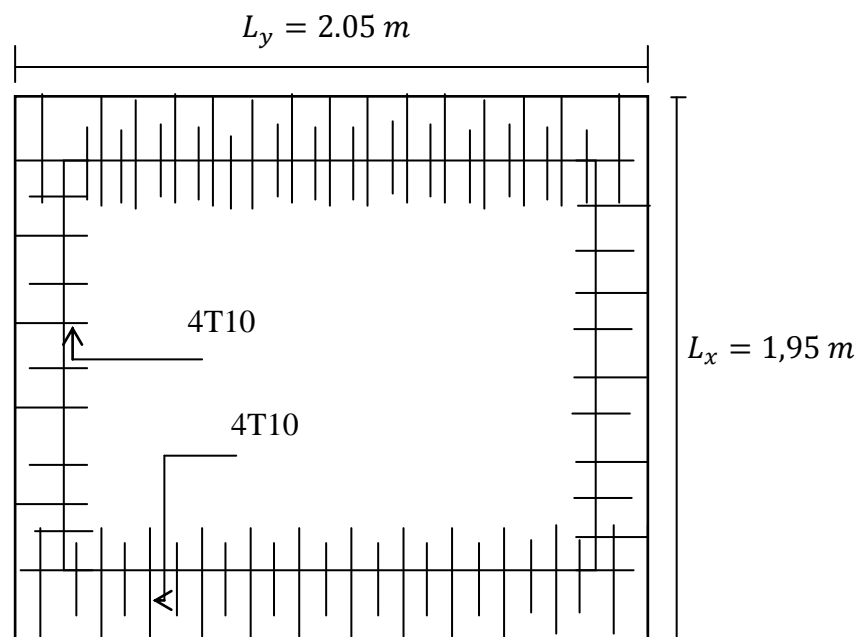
Ferrailage supérieur de la dalle de l'ascenseur.
